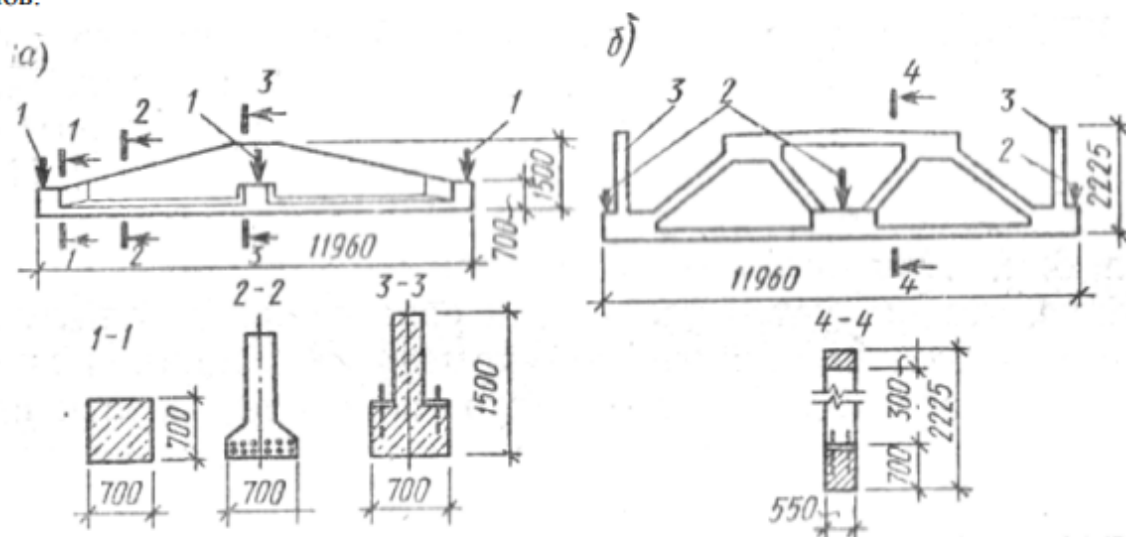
Подстропильные балки (а) и фермы (б):
